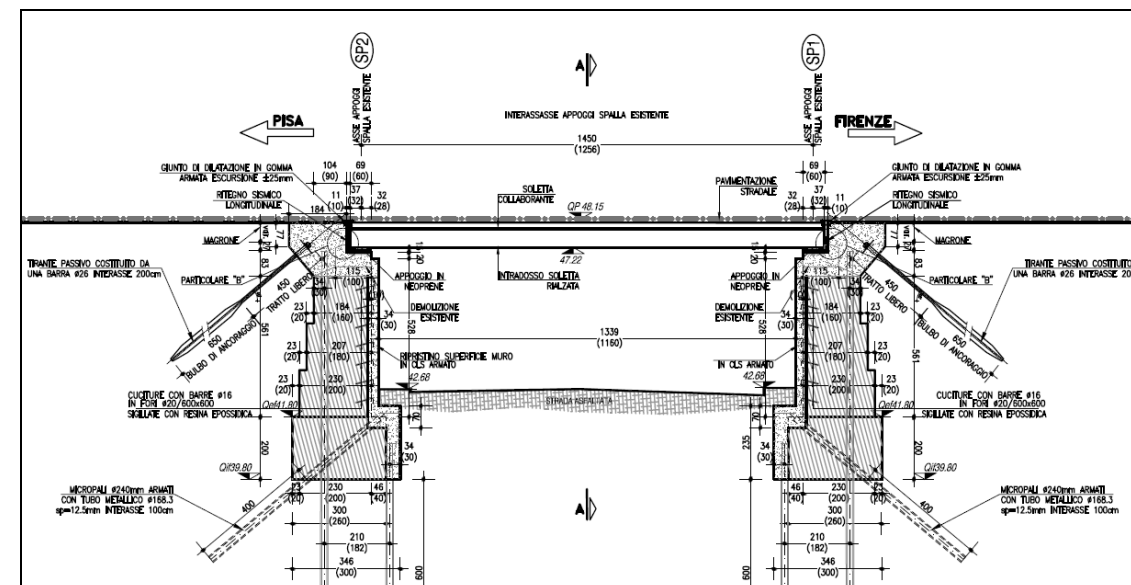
Sottovia di via Roma. Sezione longitudinale
